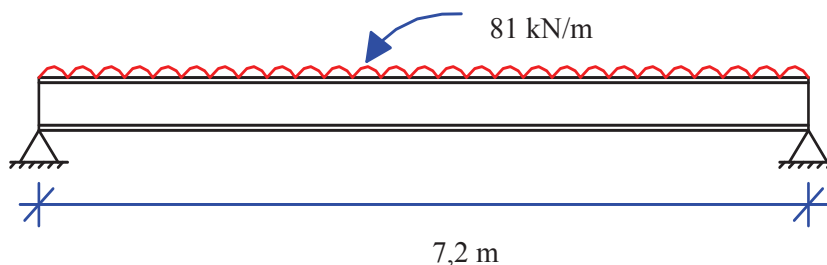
Sollicitation de la poutre de plancher (avec maintien latéral)
